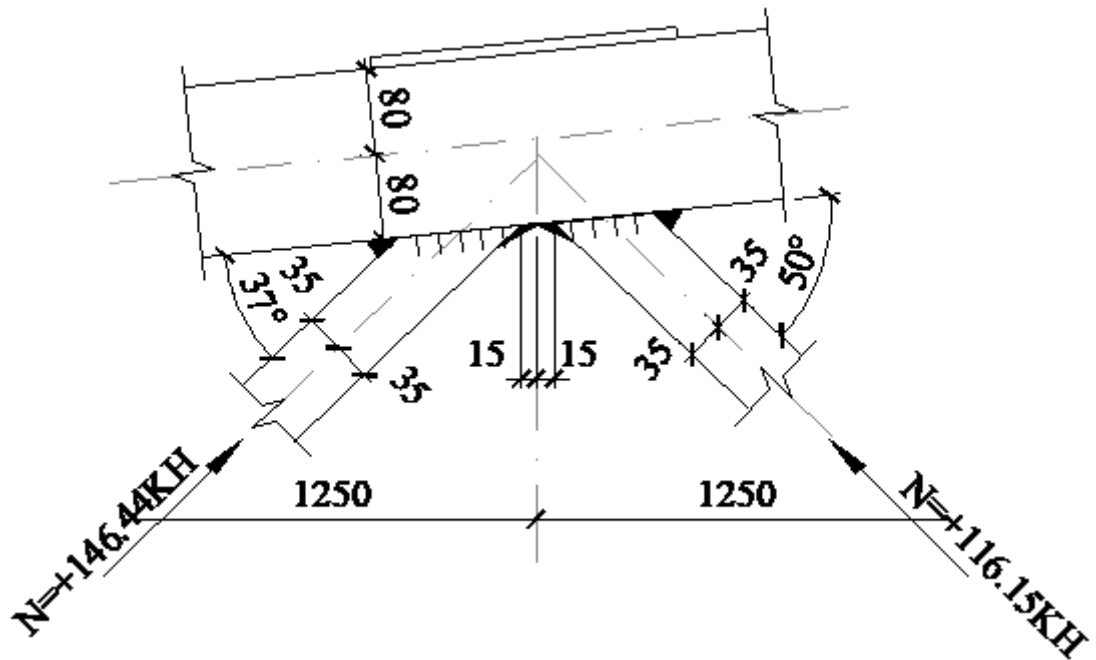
Вузол з'єднання розкосів та верхнього пояса ферми покриття
